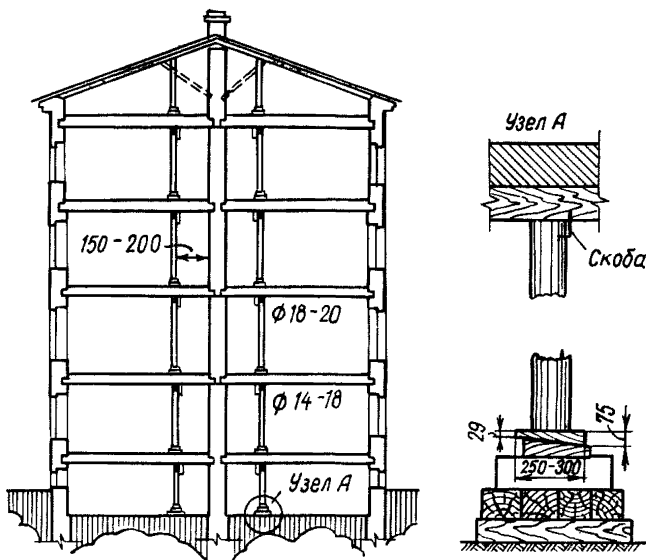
Установка временных креплений при перекладке участка средней продольной стены с сохранением существующих перекрытий
